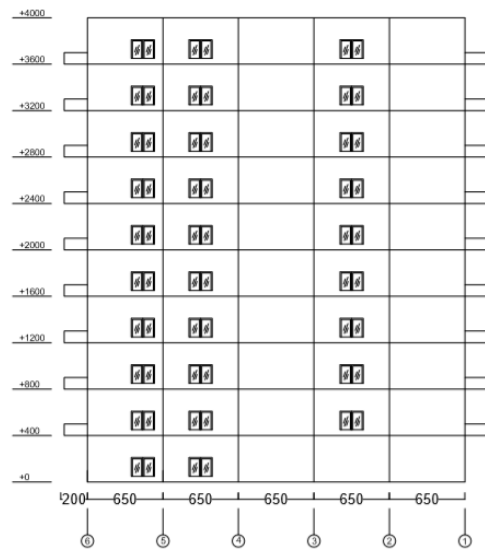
dan Gambar 3 adalah tampak depan dan tampak samping kiri. Gambar 4 dan Gambar 5 adalah denah lantai gedung apartemen.
